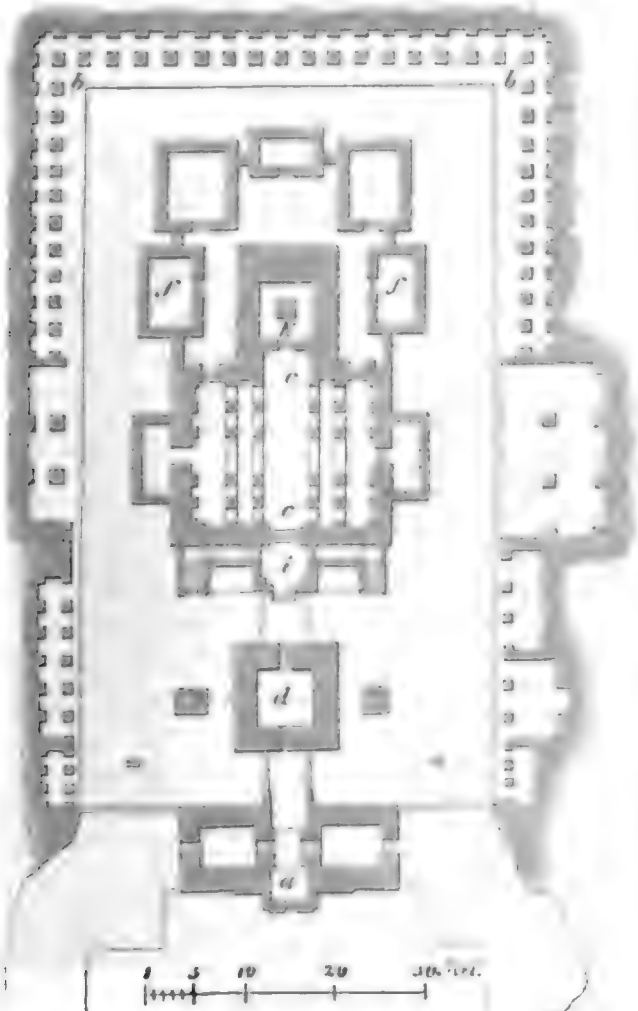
Grundriss der Keshava in Ellora.
